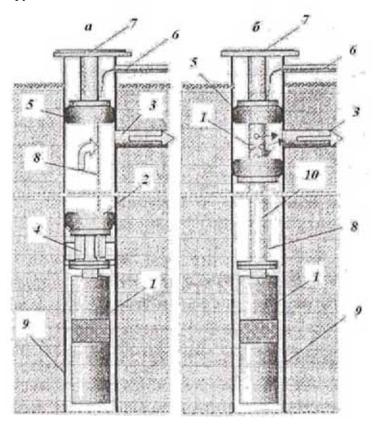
Схема установки погружных насосов в водозаборных скважинах: a-c беструбной подвеской; $\delta-c$ водоподъемными трубами; l- погружной насос; 2 и 5- соответственно нижний и верхний пакер; 3- соединительный трубопровод; 4- беструбная подвеска; 6- трубка для кабеля; 7- опорный фланец; 8- электрический кабель; 9 и 10- соответственно обсадная и водоподъемная труба
